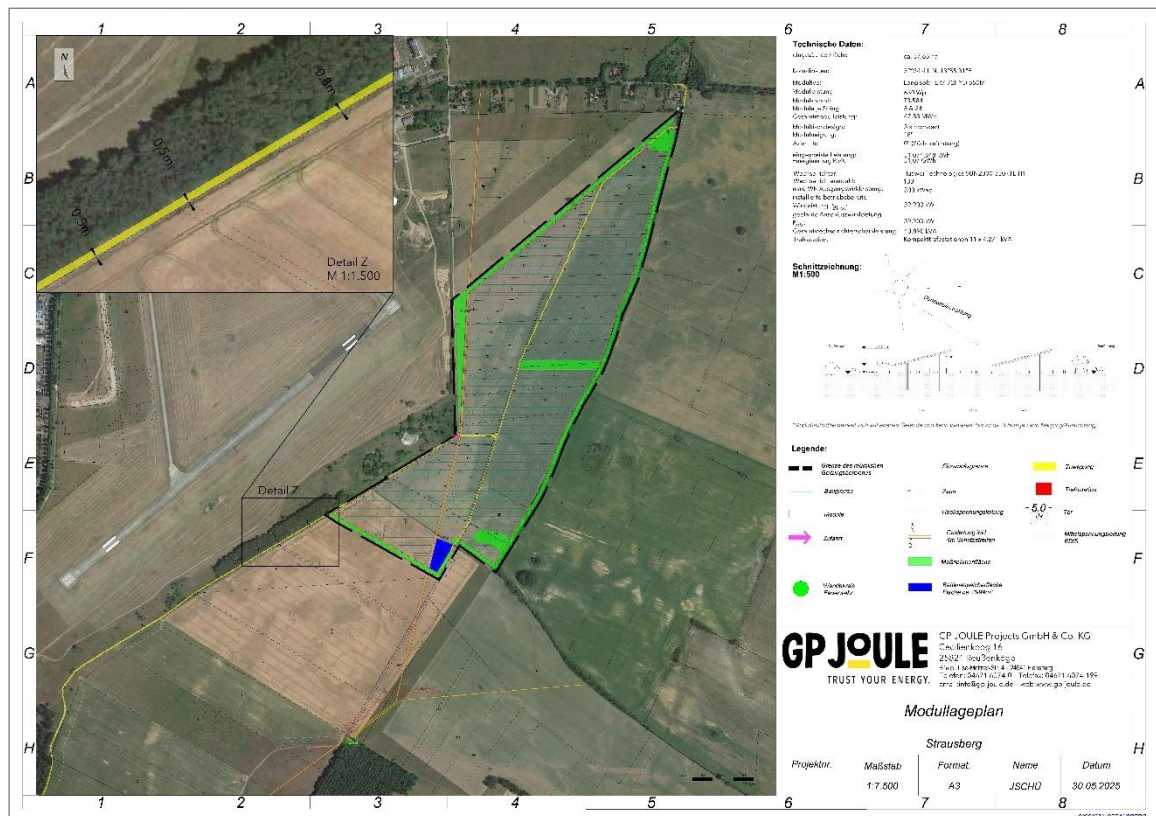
Modul Lageplan, Stand 30.05.2025
